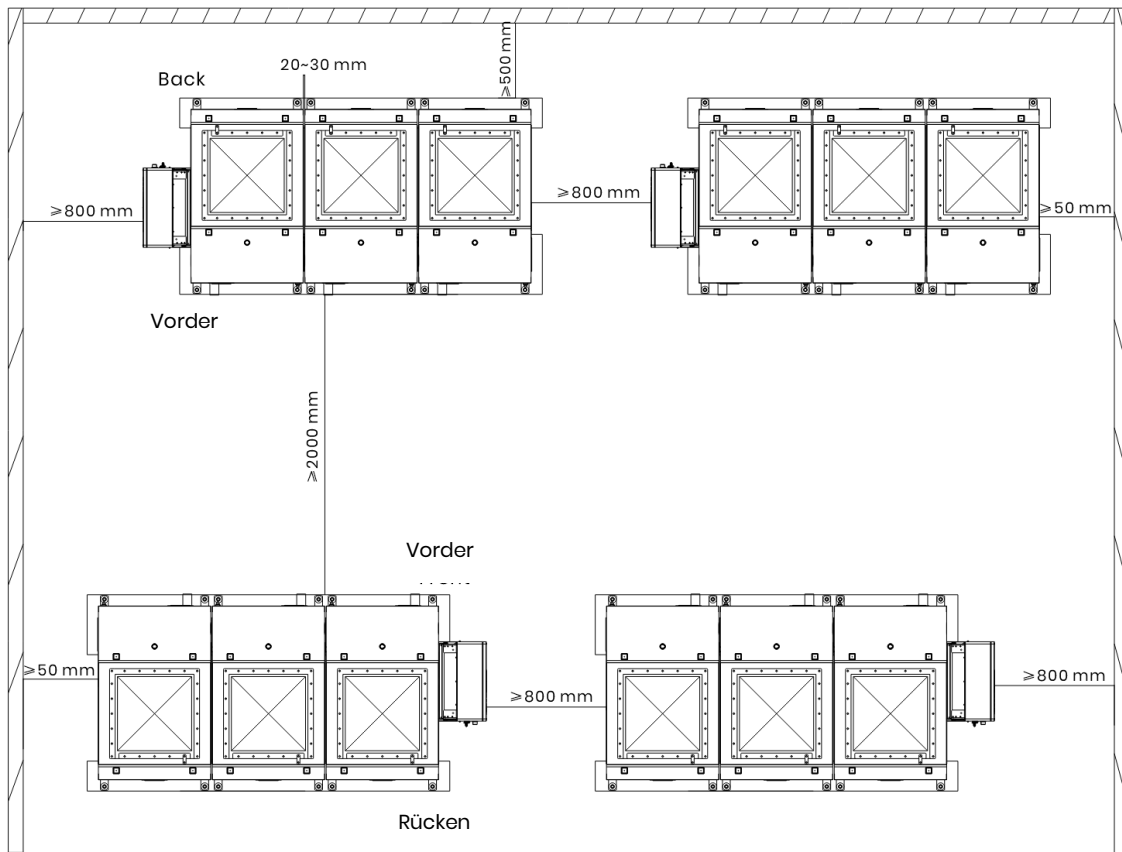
Installation von Angesicht zu Angesicht (Draufsicht)
